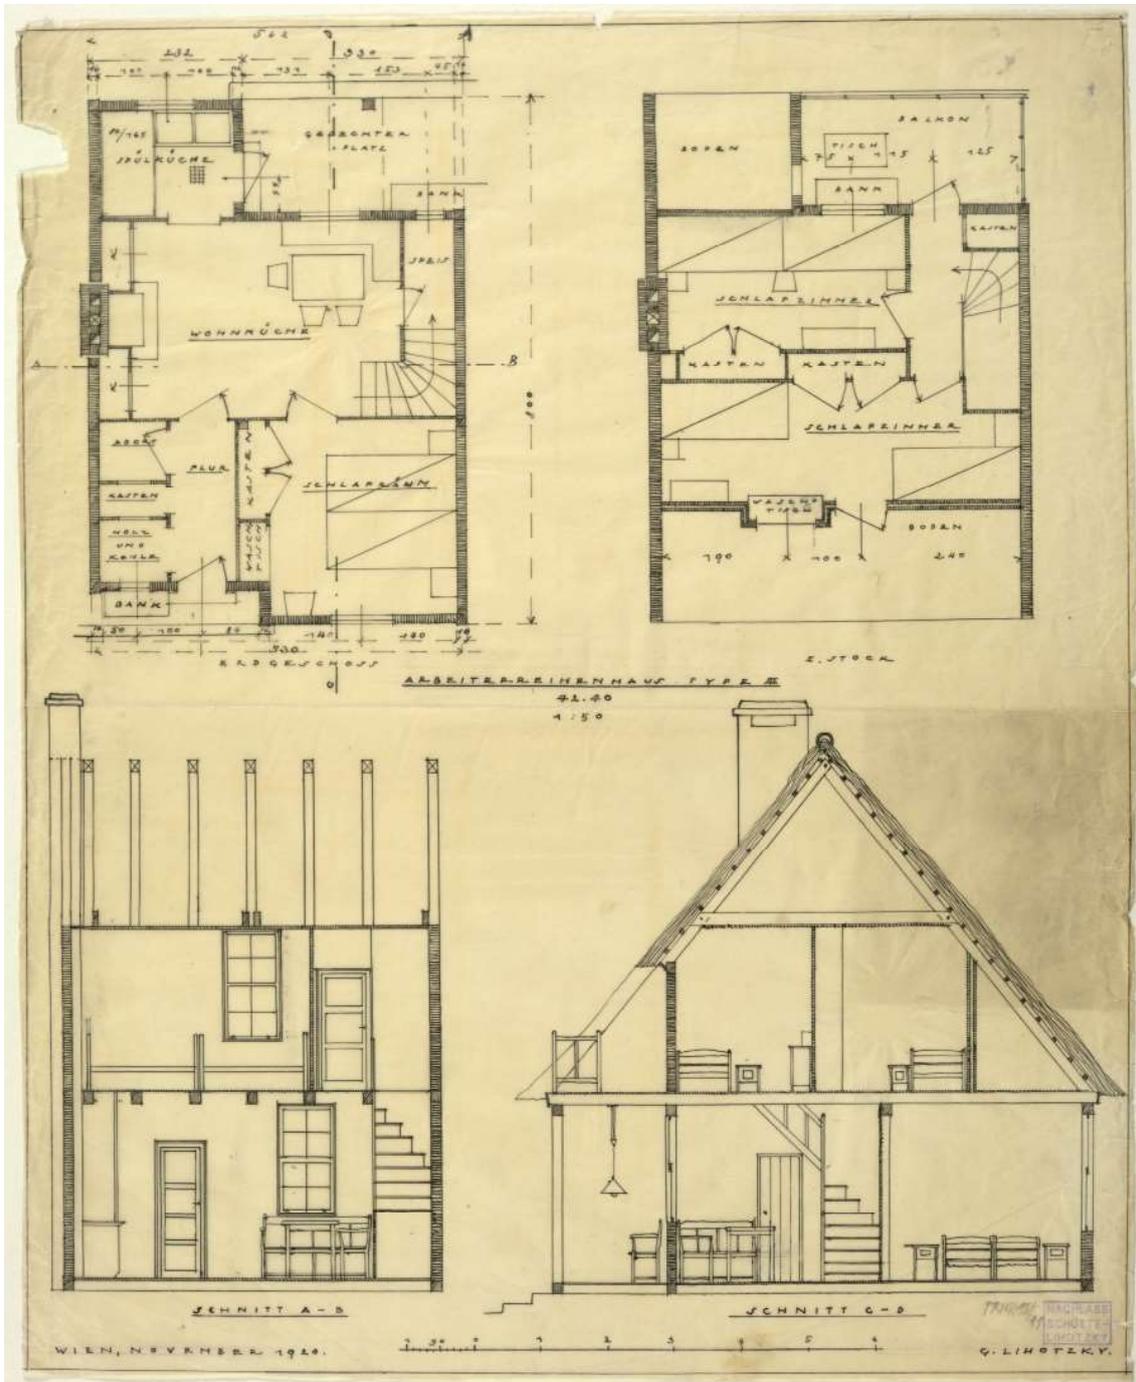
Abb.XLI: Arbeiter-Reihenhaus Type III, Grundriss und Schnitt.1920.
